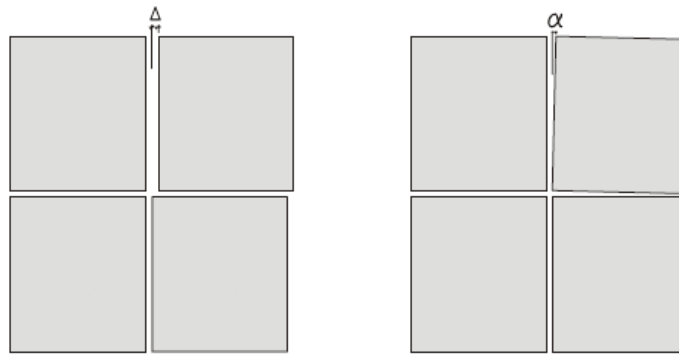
desvios de posicionamento de painéis no plano da fachada
